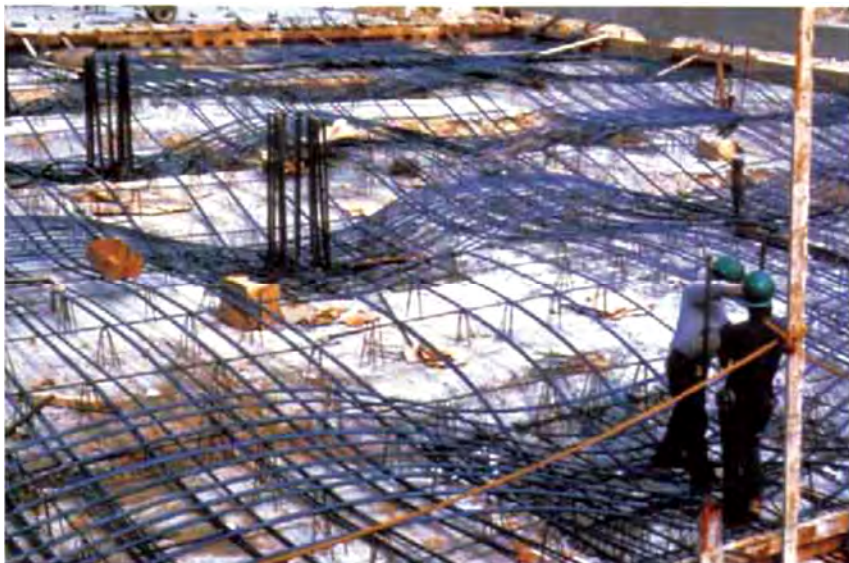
Пример устройства сильно нагруженной фундаментной плиты с предварительно напряженной арматурой
